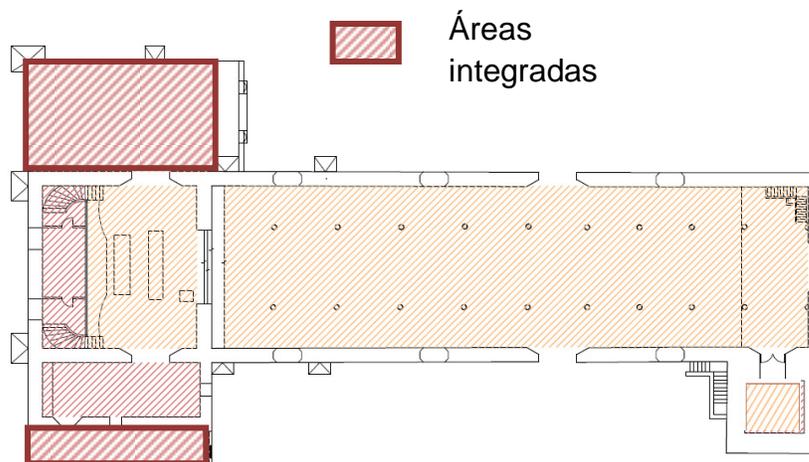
Planta. Fuente: Grupo de trabajo.
